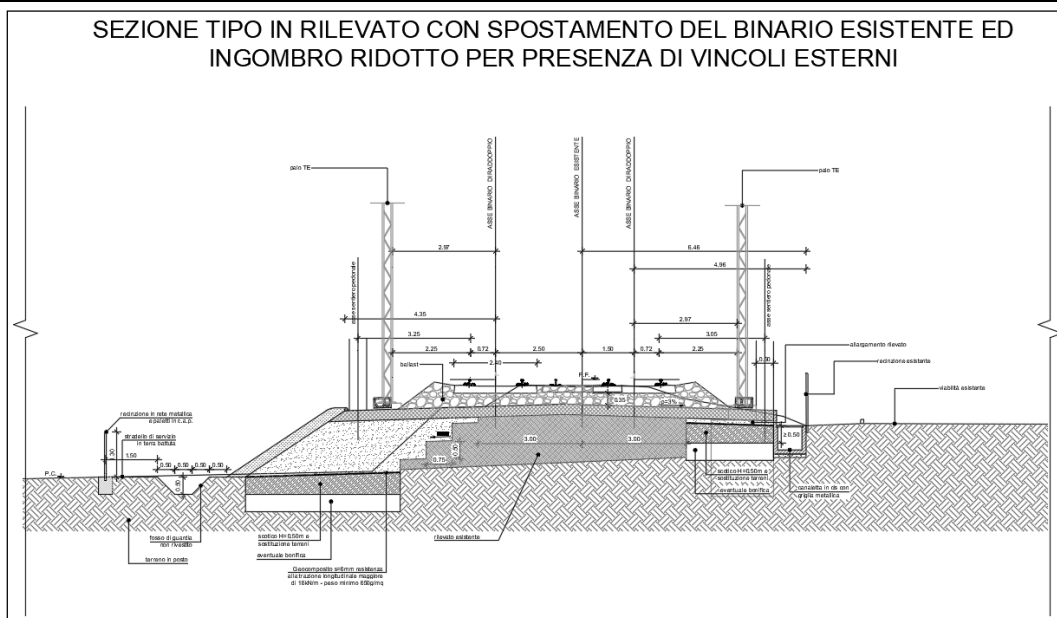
Sezione tipo in rilevato con spostamento del binario esistente
